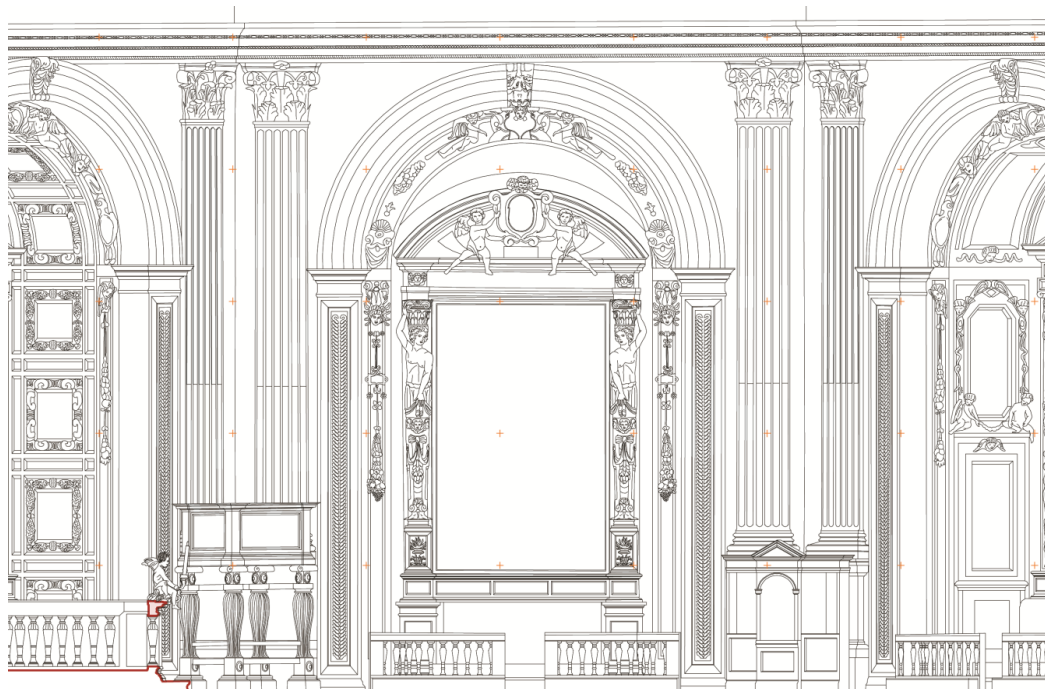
Dettaglio della sezione longitudinale. Originale in scala 1:50.
